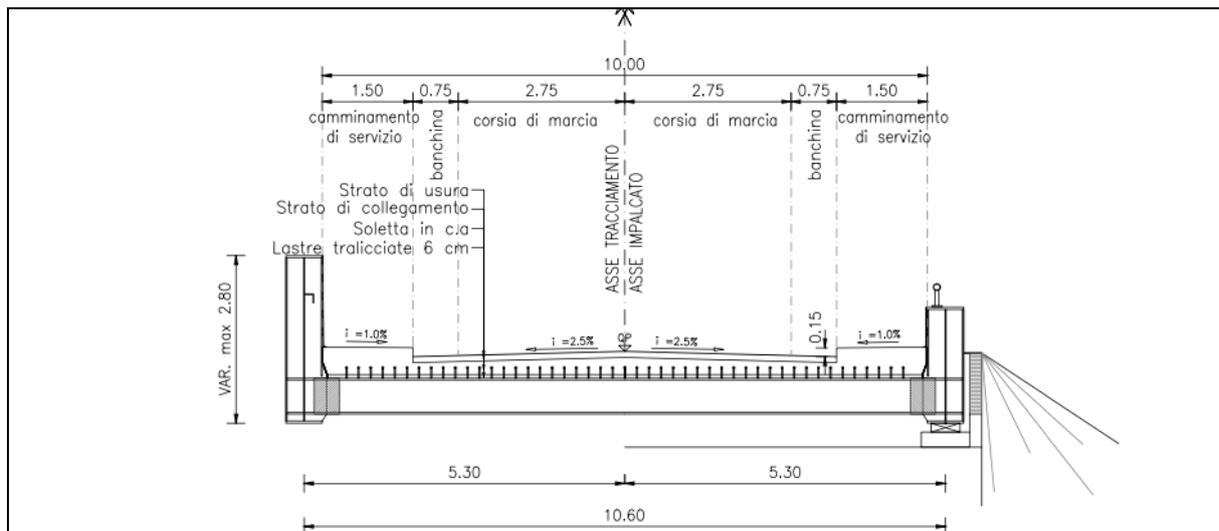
NV_ASSE 2: Ponte stradale sul Torrente Evigno - Sezione tipo in viadotto
